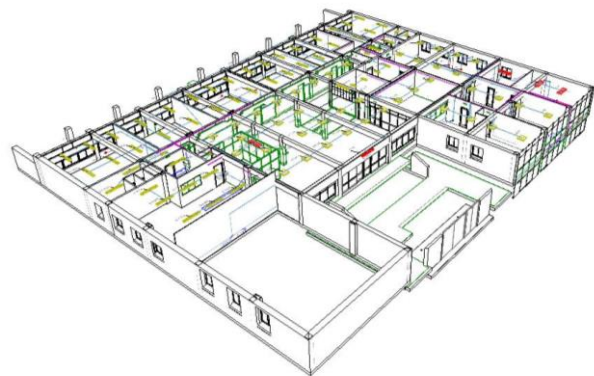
Planta baja. Perspectiva generada desde DDS-CAD
